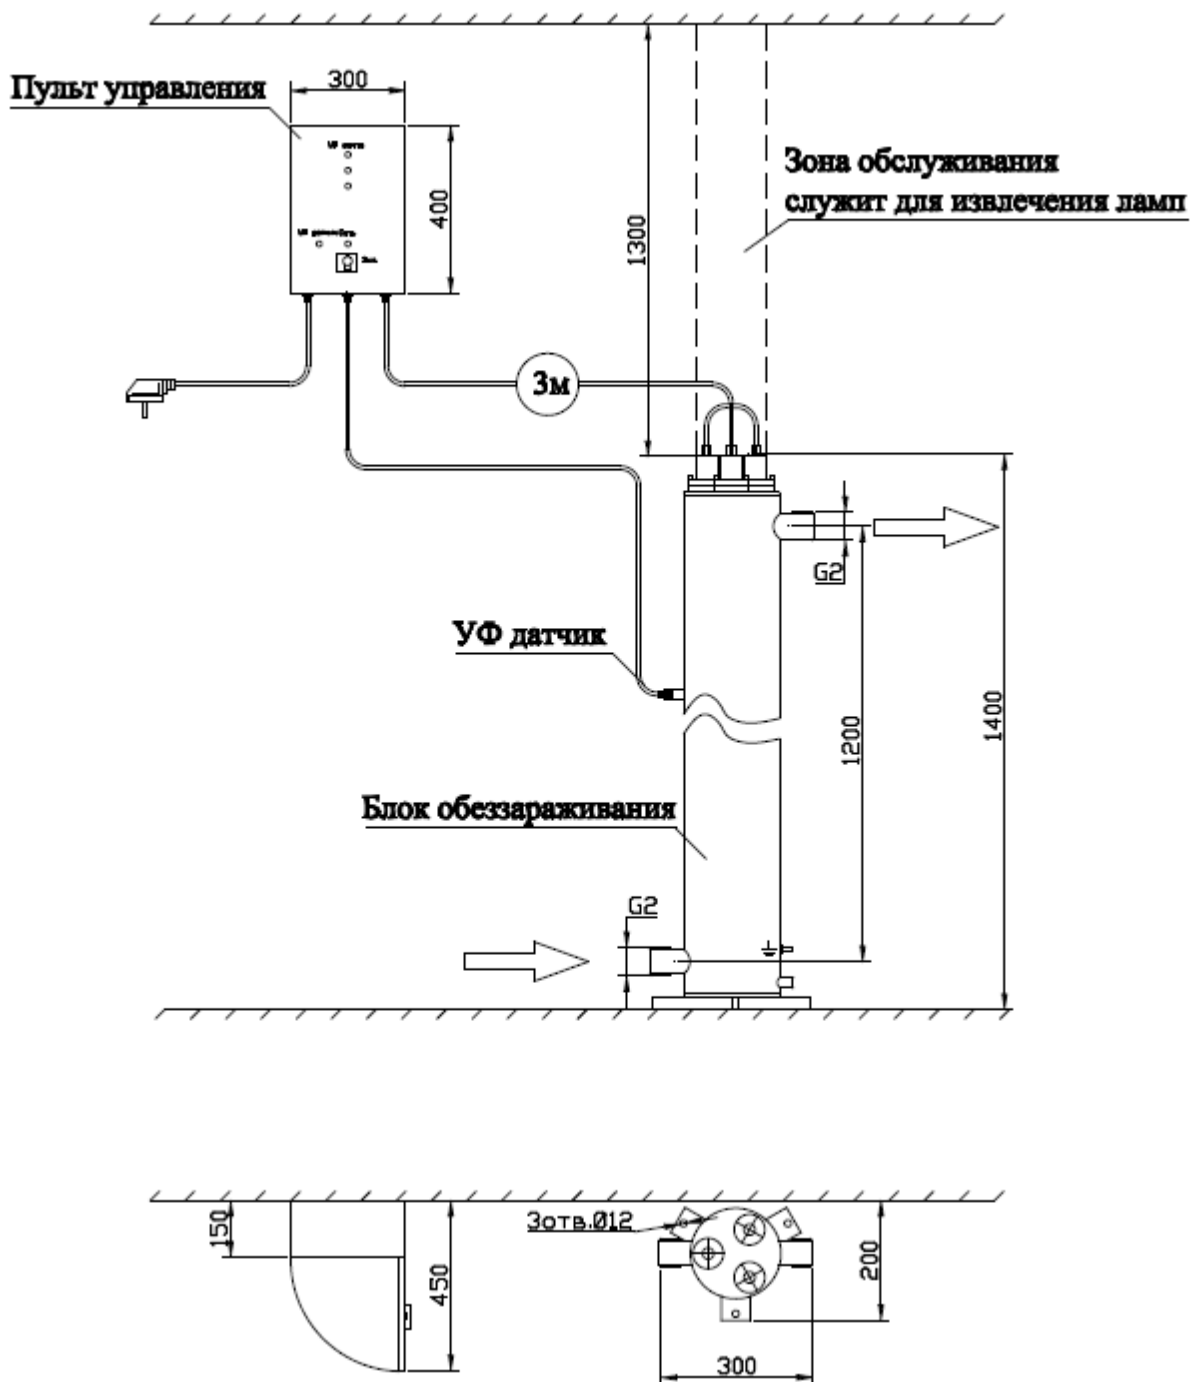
Габаритные размеры установки ОДВ-15
